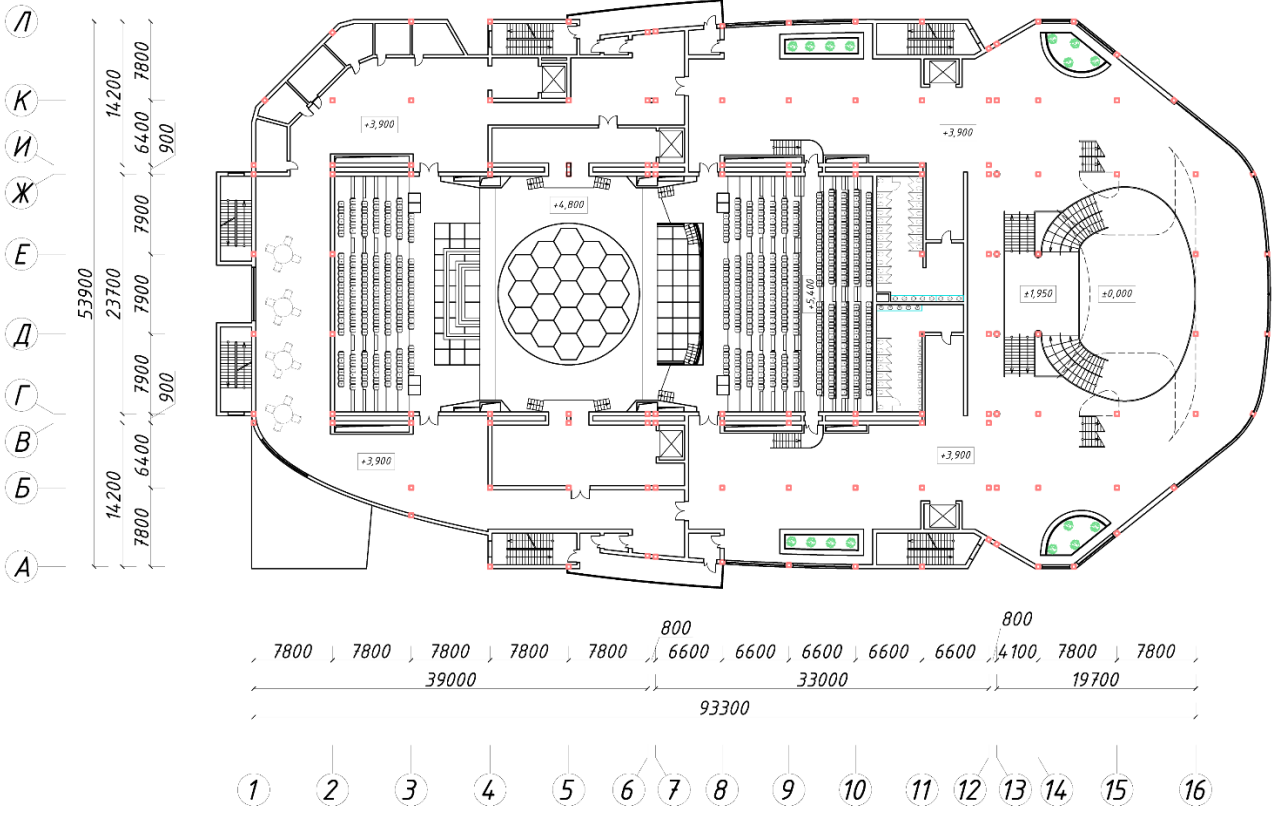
Схема плану поверху на позначці +5.400.
